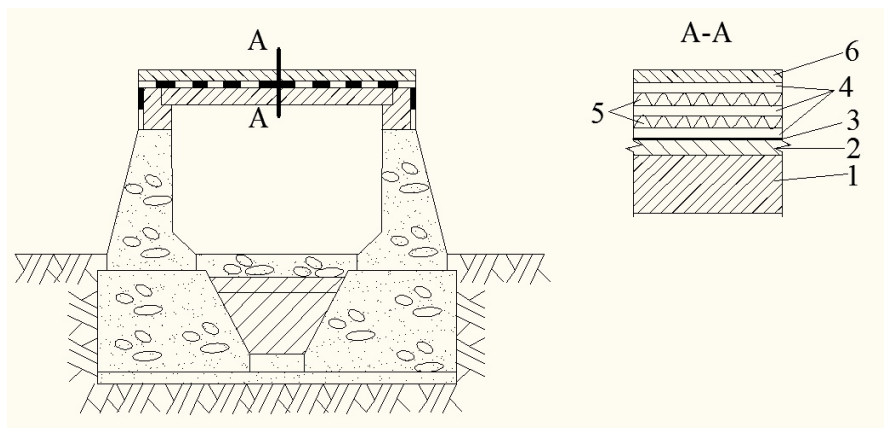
Гидроизоляция типа БМ-1 для сборных железобетонных прямоугольных водопропускных труб:
